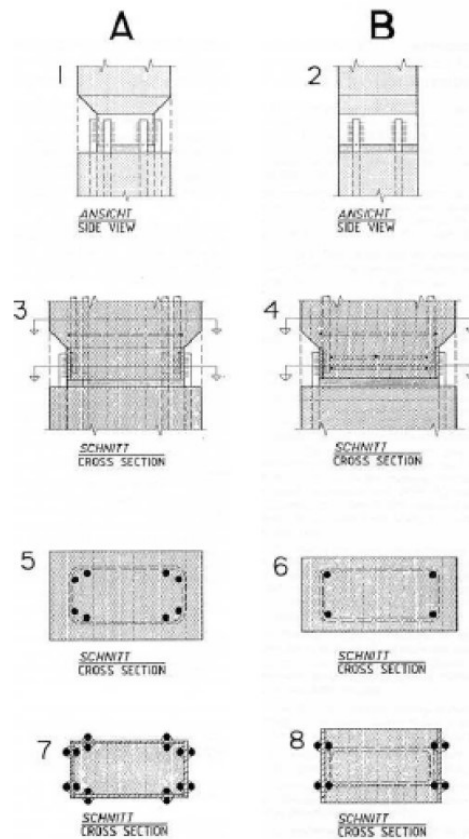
Ligação por soldagem de chapas a barra de aço (Stupré, 1981)
